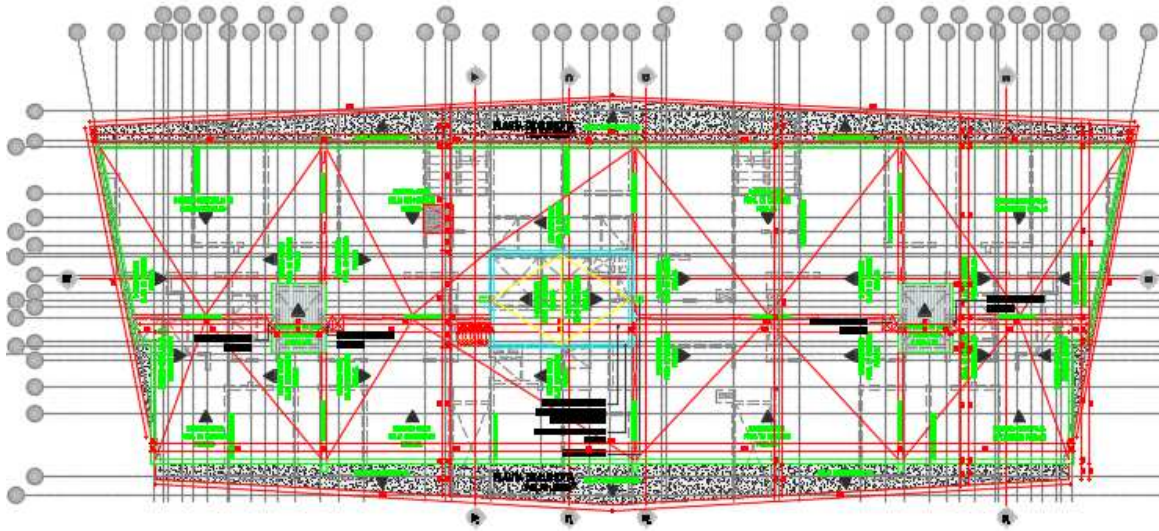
Planta arquitectónica de cubierta. Fuente: Diseño arquitectónico.
